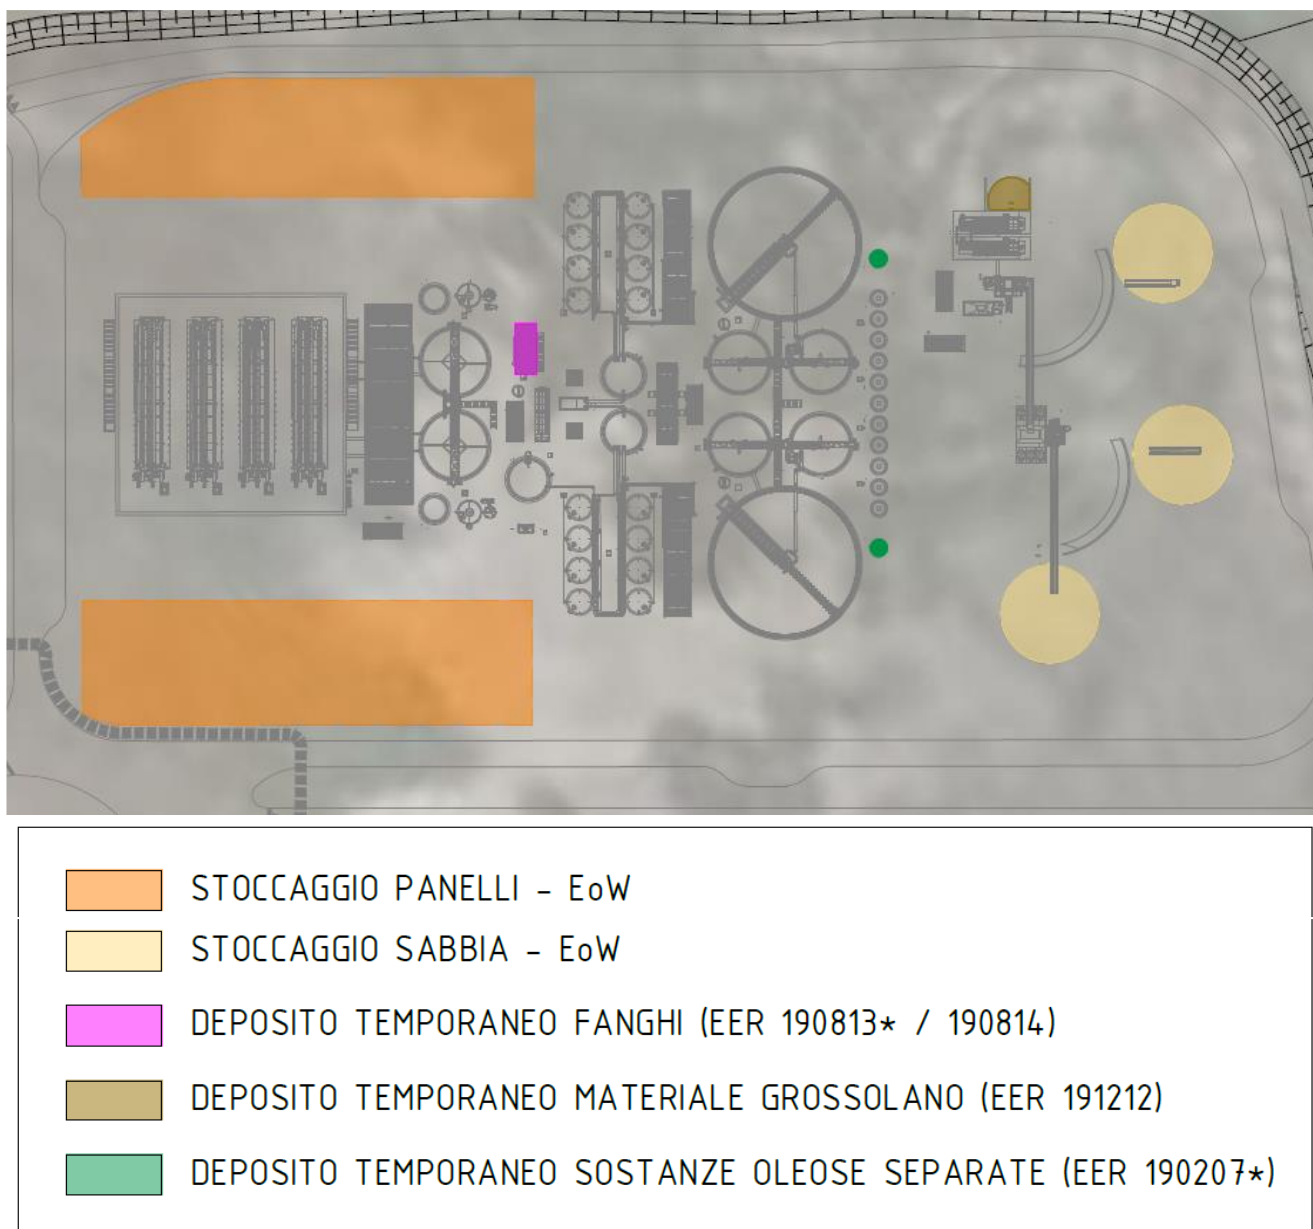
Stralcio elaborato Vol.2-Elaborato 8 PLANIMETRIA DEPOSITI E STOCCAGGI
